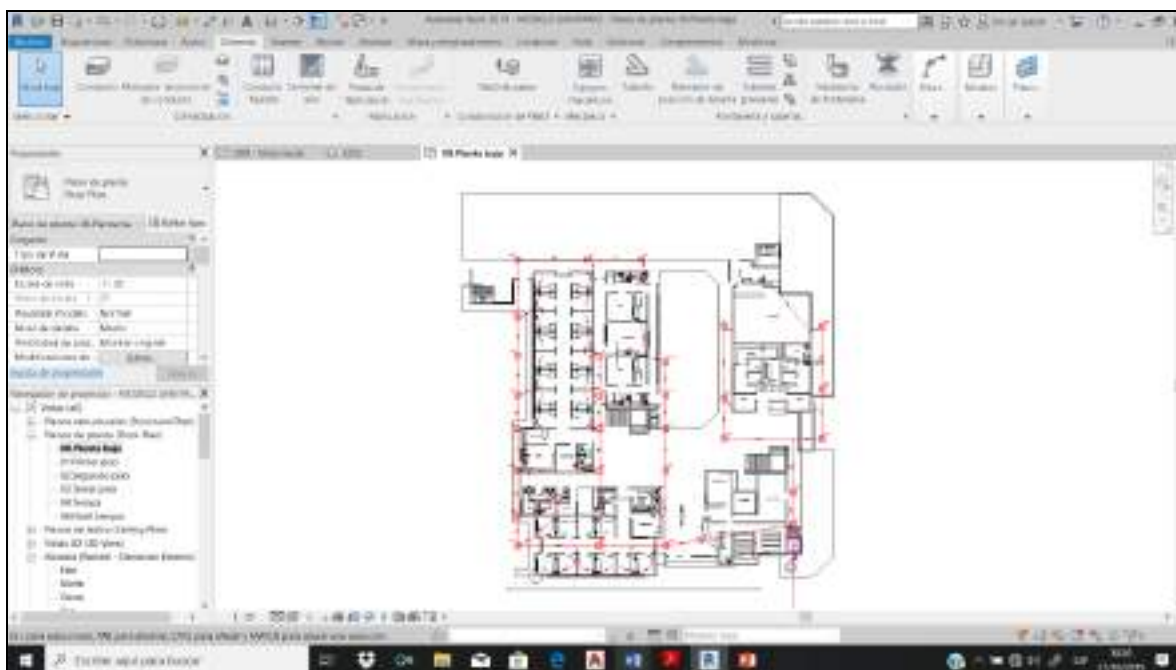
Importación del plano CAD de instalación sanitaria -Planta Baja
